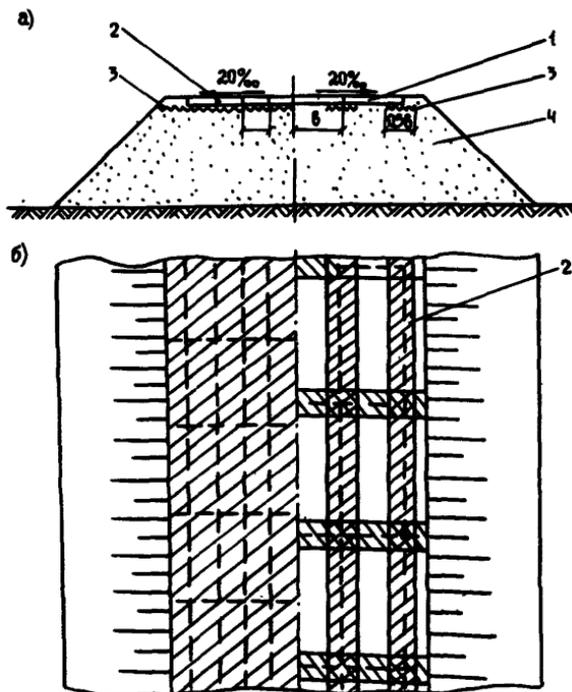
Прослойка из НСМ в основании сборного покрытия в разрезе (а) и плане (б): 1-покрытие из плит шириной более 1,5 м; 2-покрытие из плит шириной менее 1,5 м; 3-прослойка из НСМ; 4-насыпь из песка
